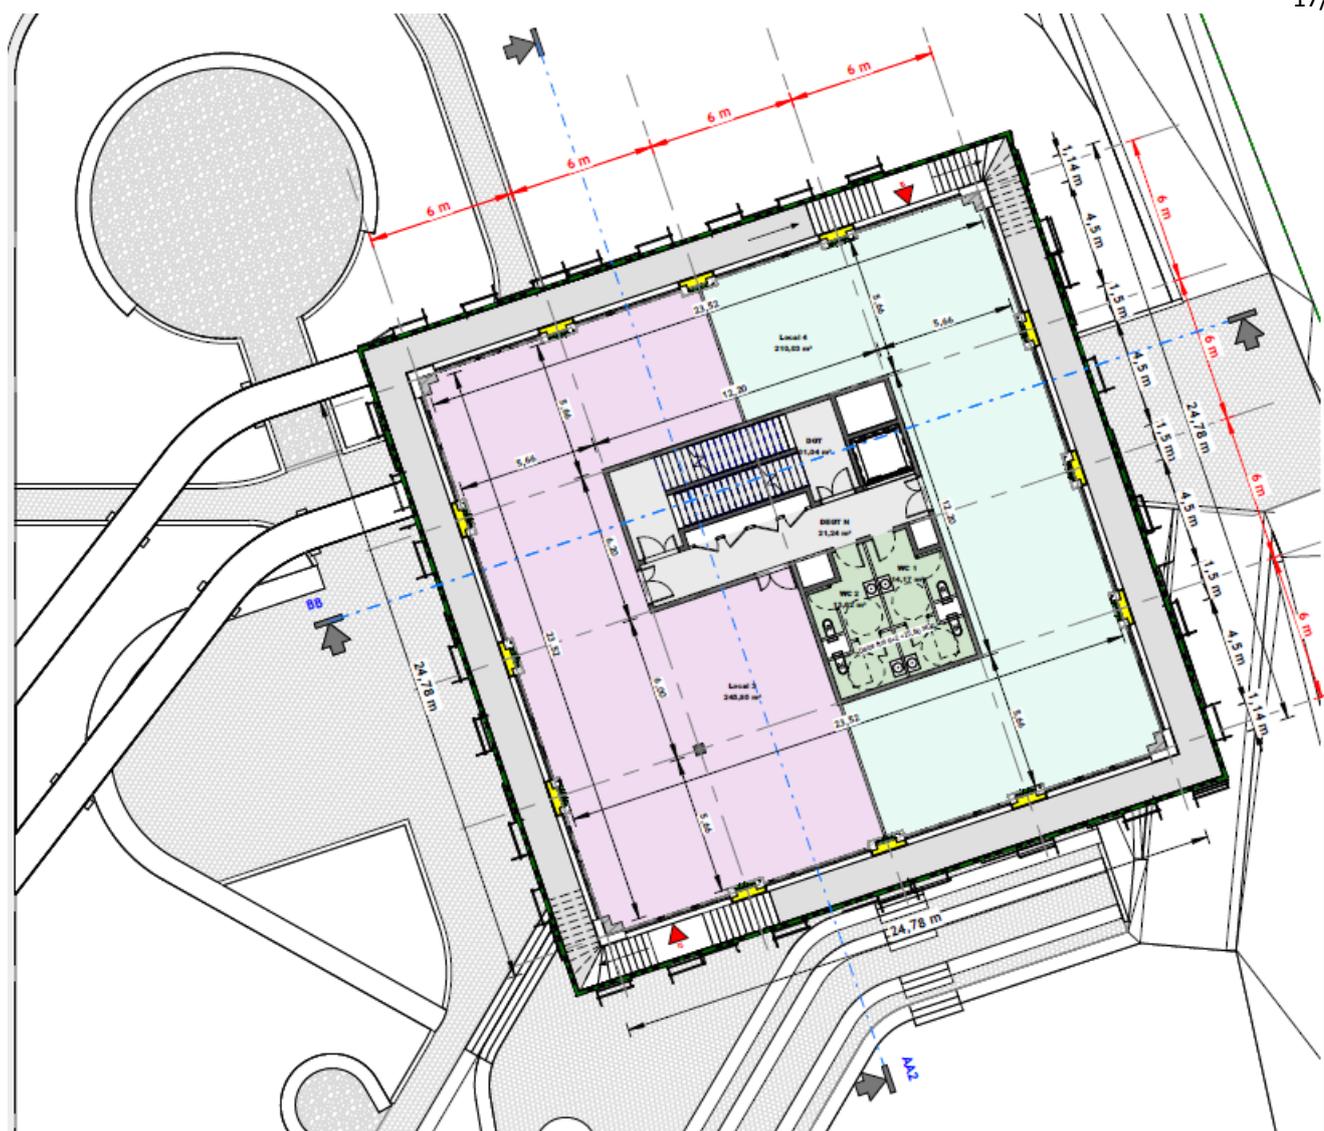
Plan de pavillon – niveau R+2 (février 2024)
